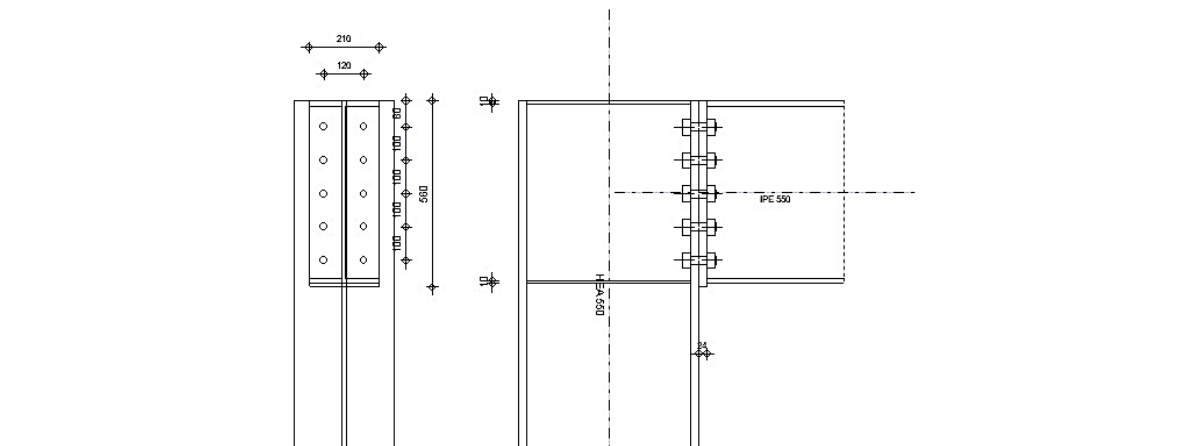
6 : Vérification de l'assemblage poteau-poutre
